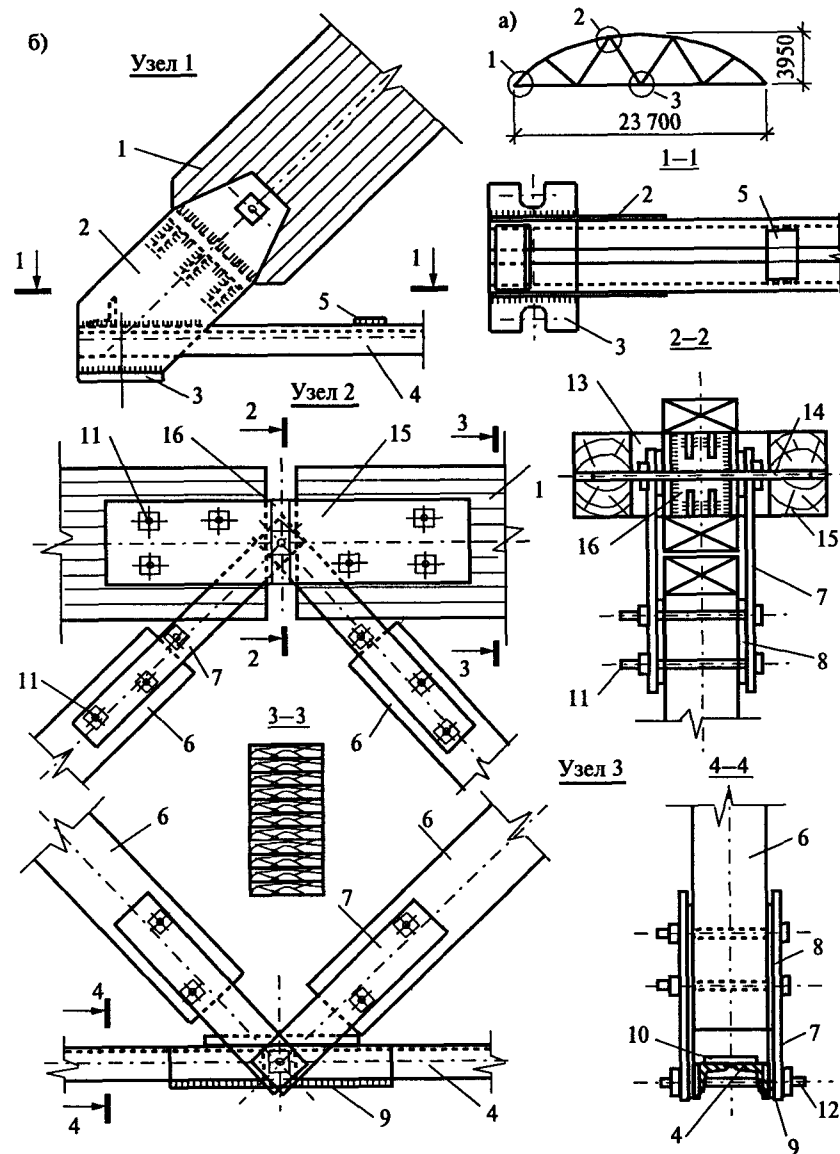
Сегментная металлодеревянная ферма: а) геометрическая схема; б) узлы фермы: 1 — верхний пояс; 2 — щеки башмака; 3 — опорная плита; 4 — нижний пояс; 5 — планки; 6 — раскосы; 7 — планки; 8 — подкладки; 9 — стыковые накладки; 10 — накладки; 11 — болты; 12 — узловой башмак с ребрами; 13 — вырез в накладках; 14 — болт; 15 — накладки; 16 — сварной башмак с ребрами
